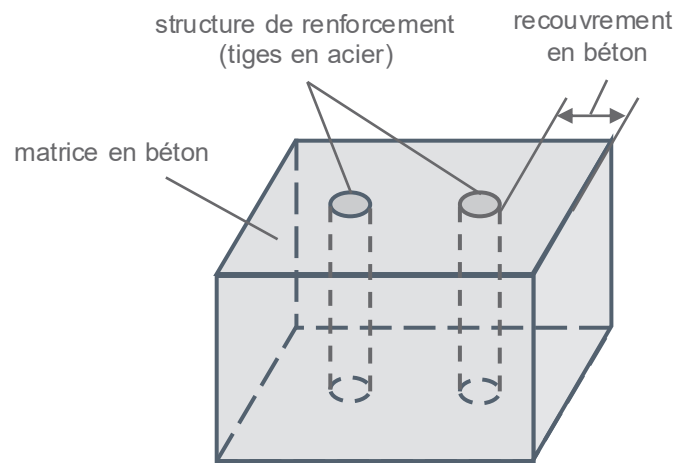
Élément de construction en béton armé avec recouvrement en béton
